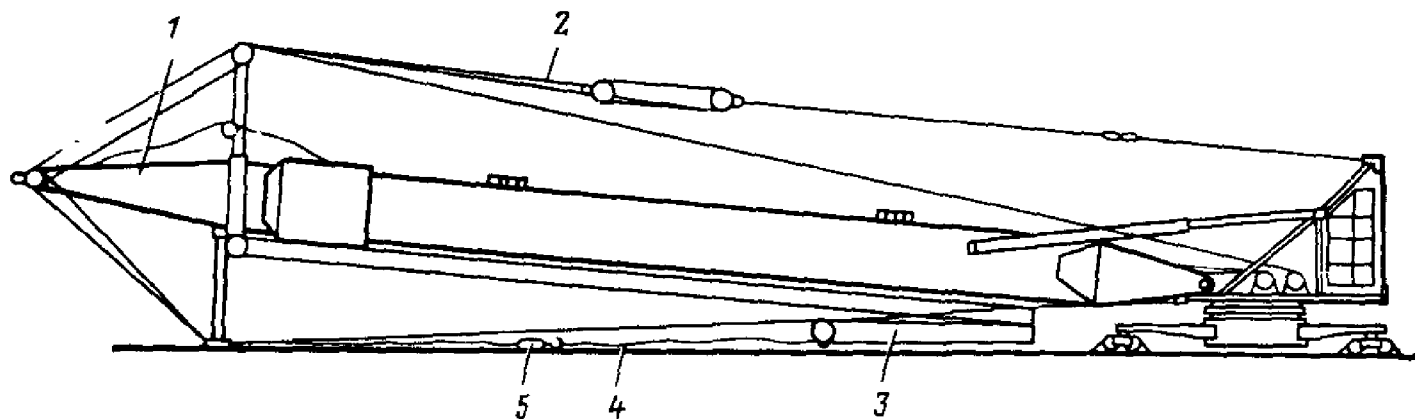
Схема подвески головной секции стрелы на грузовом канате:
